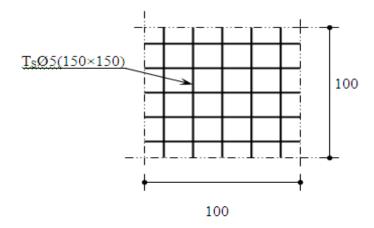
Schéma de ferraillage de la dalle de compression.
